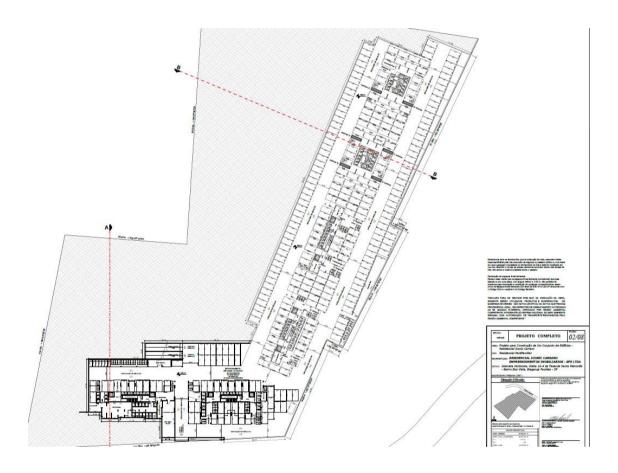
Projeto - 2º Subsolo. (Para melhor visualização ver anexo correspondente).
